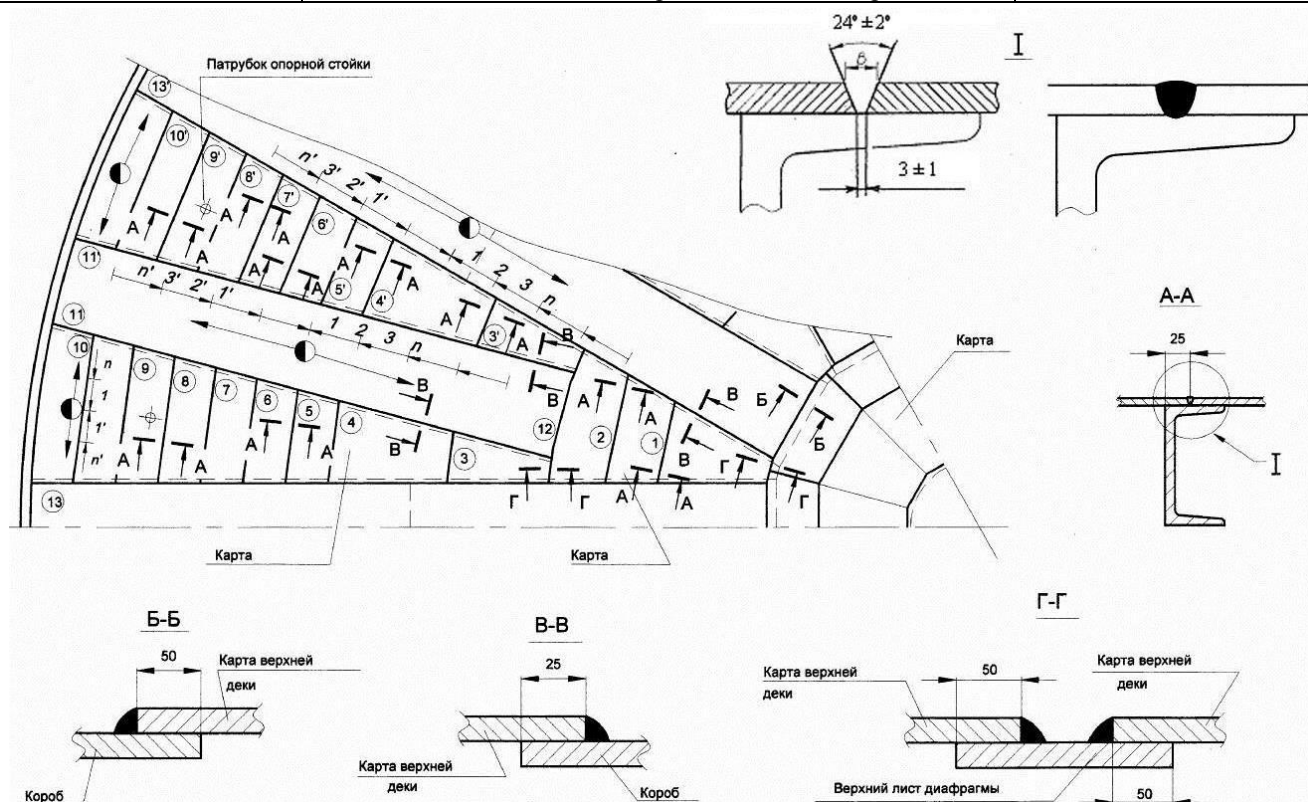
Схема сварки соединений плавающей крыши
